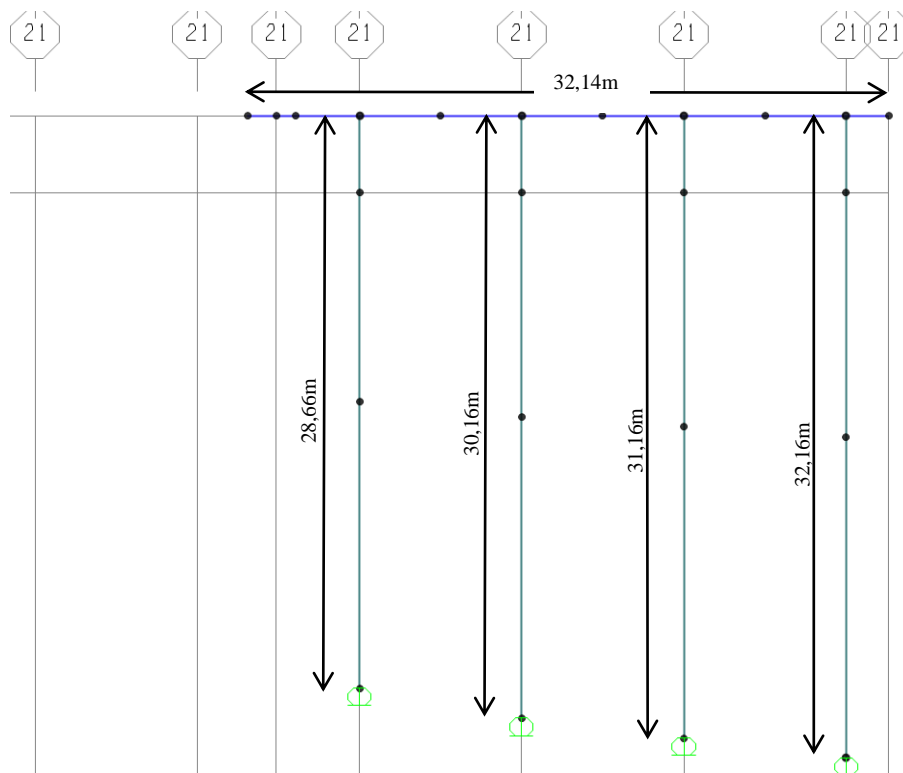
Vista en elevación del plano 21 de geometría, paralelo a plano Y-Vertical'.
